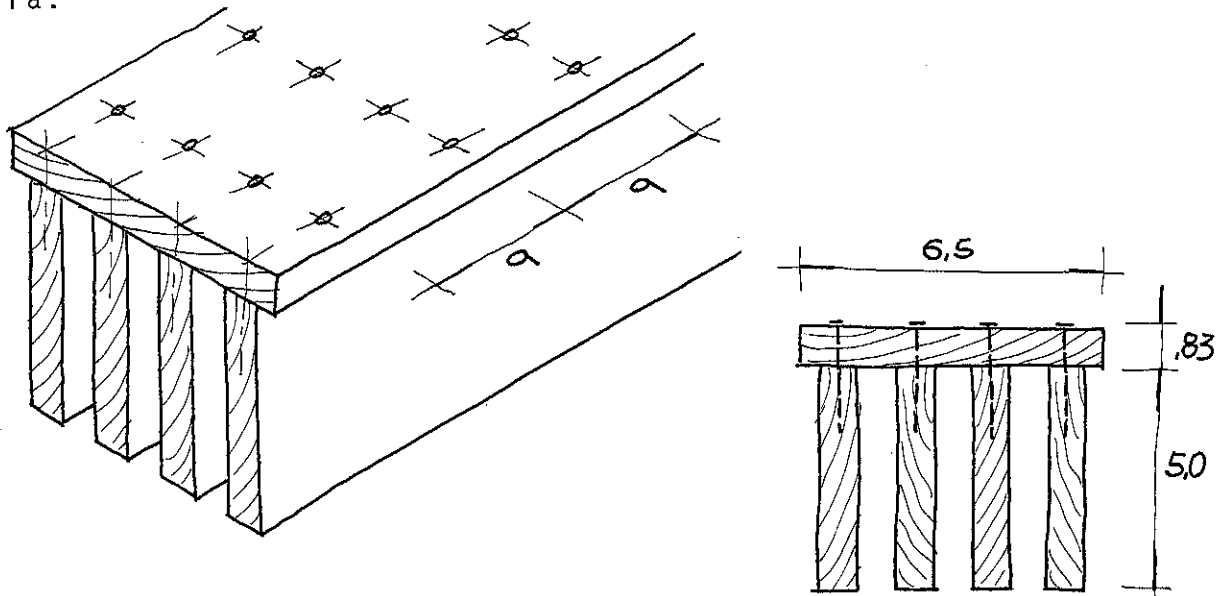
Travamento das Barras da Coluna Lateral do Pilar
